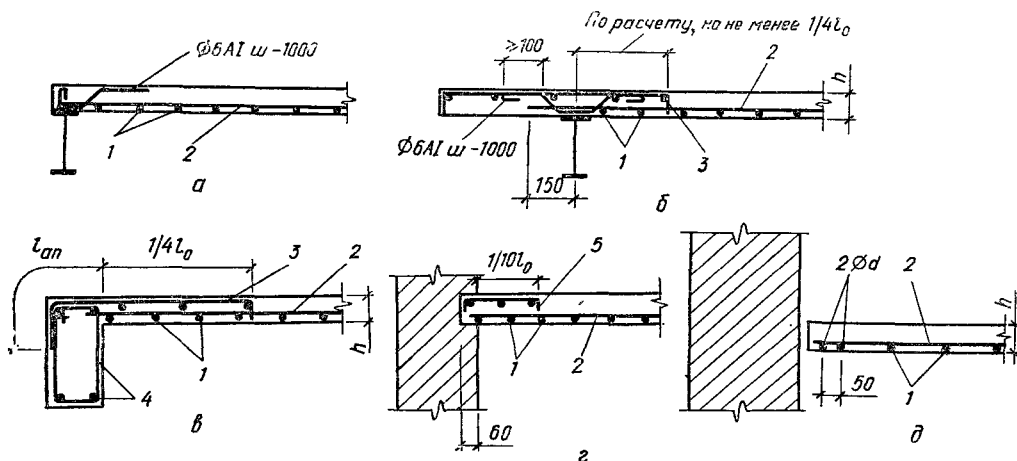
Раздельное армирование крайних опор монолитной плиты отдельными стержнями в нерабочем направлении:
